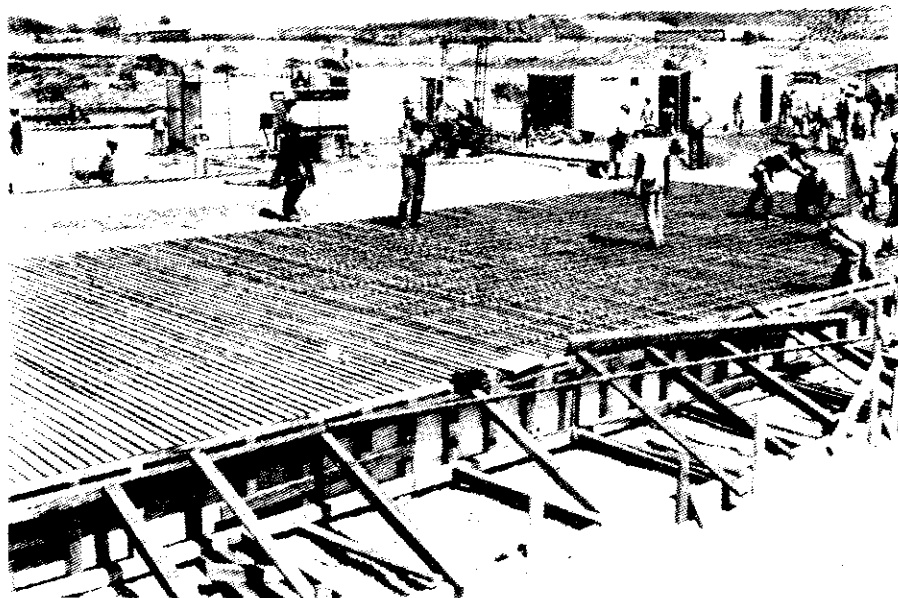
Preparativos para a concretagem da lage de fundo de um dos tanques de aeração da ERO de Barueri.
